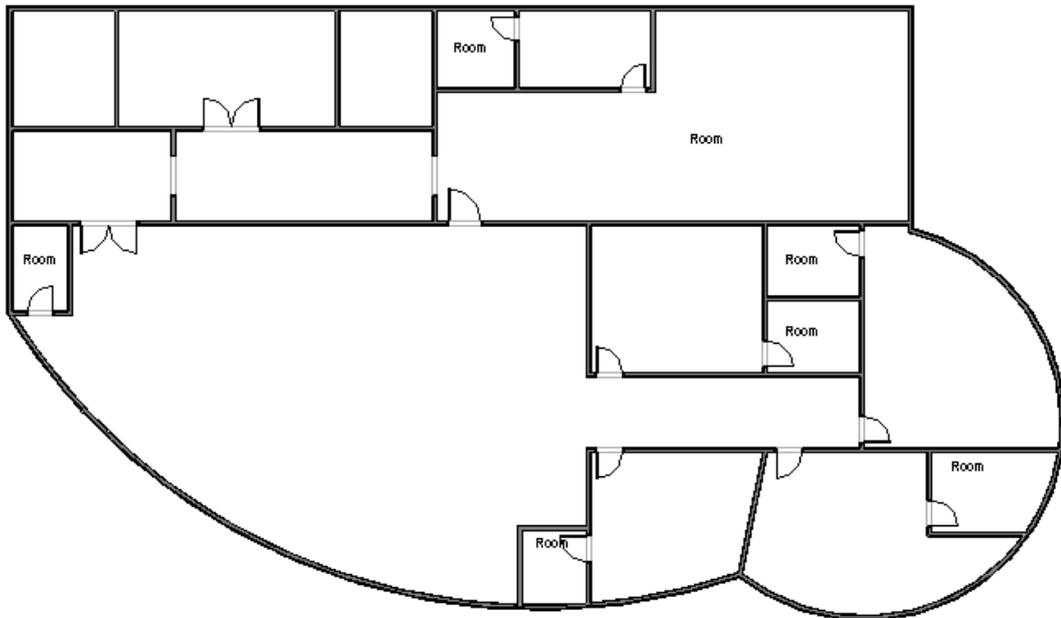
Planta Tipo 3 em Autodesk Revit 2017.
